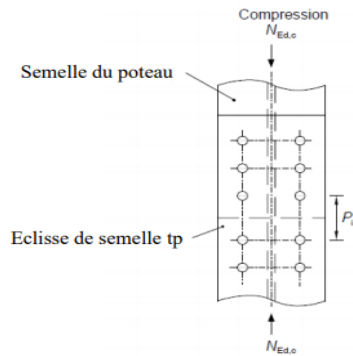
Disposition des boulons couvre-joint semelle pour la compression.
